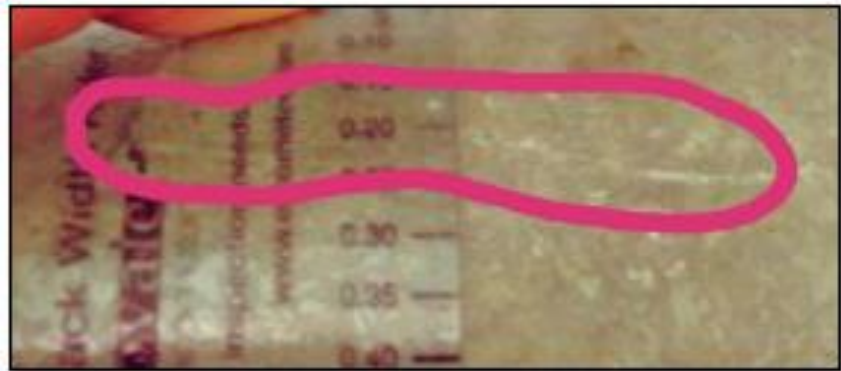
En el día 98 está grieta midió 0.20 mm de ancho.
